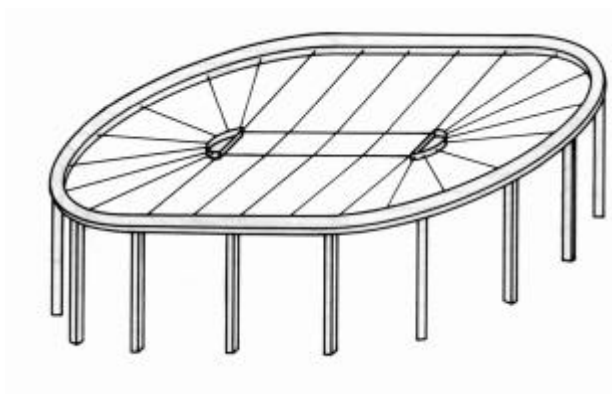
Cesta não protendida para cobertura de planta oval.
